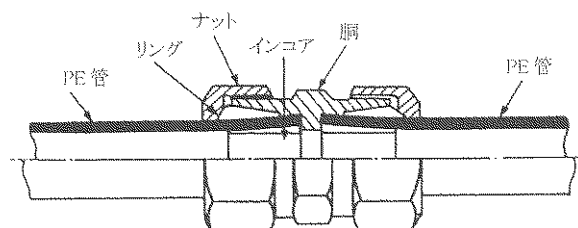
水道用ポリエチレン管金属継手(JWWA B 116)の接合方法
